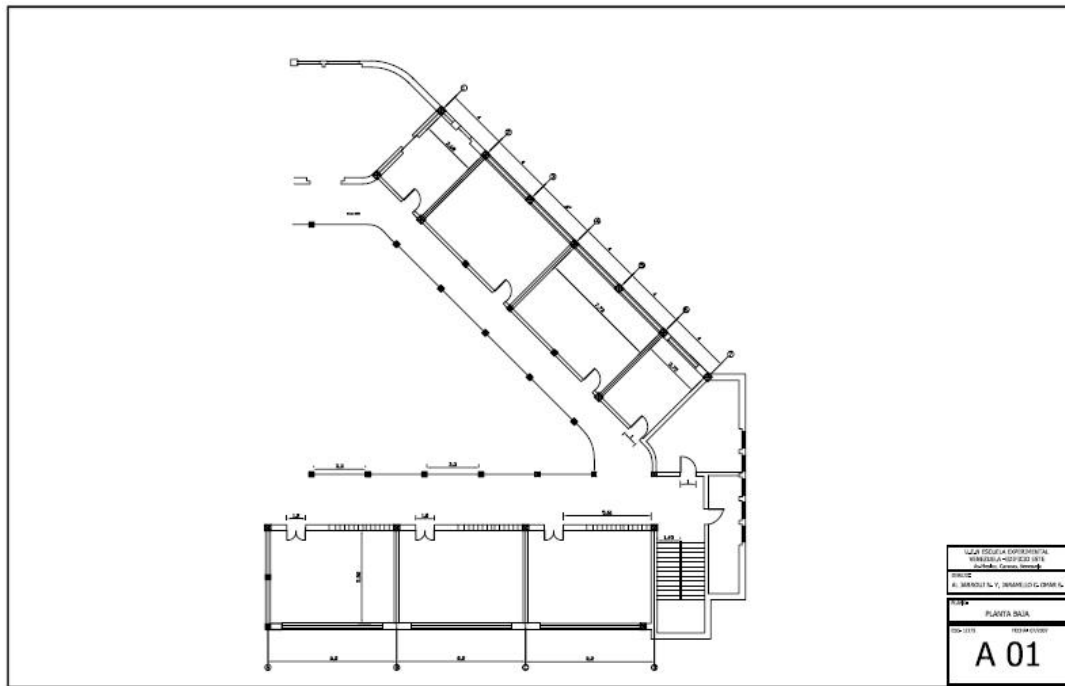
Plano digital de arquitectura de la planta baja del edificio este
